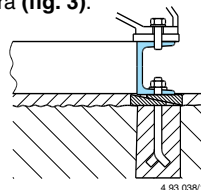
Fondazione per gruppo su piastra di base di profilati saldati.
